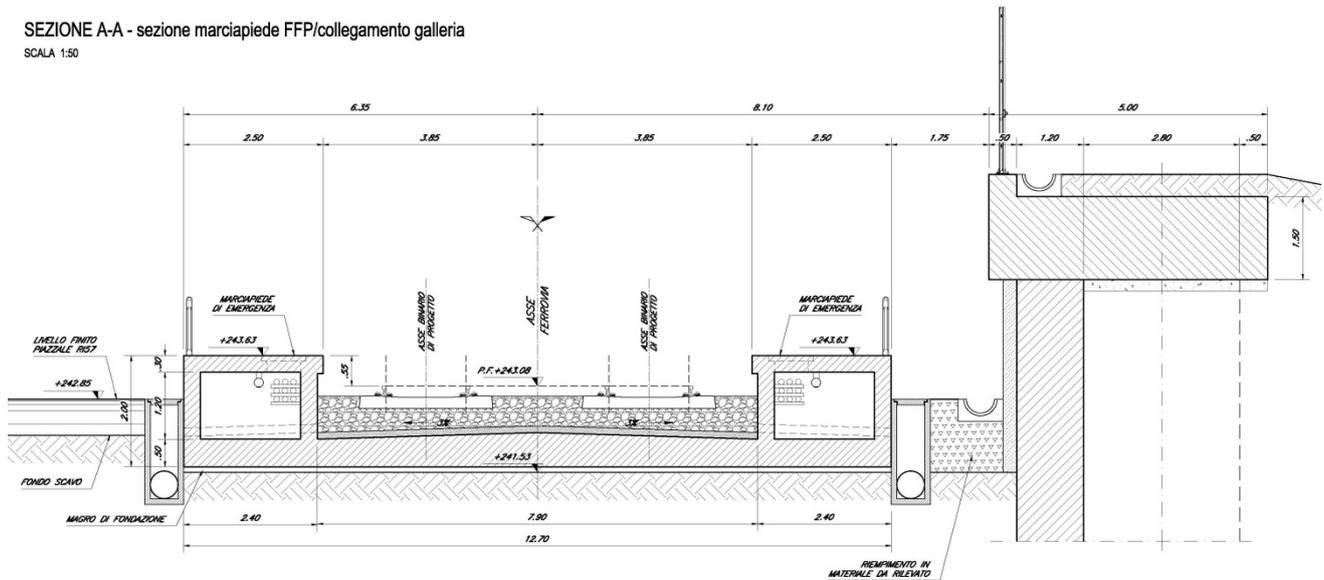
Sezione tipo del manufatto – concio 1 & concio 2
